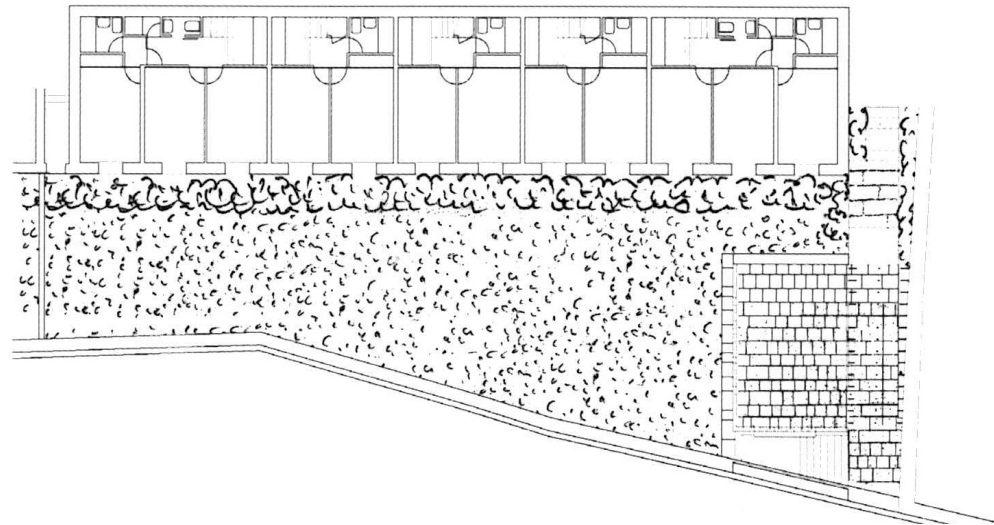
Planta baja de la Vaquería del Carmen de Abaixo
